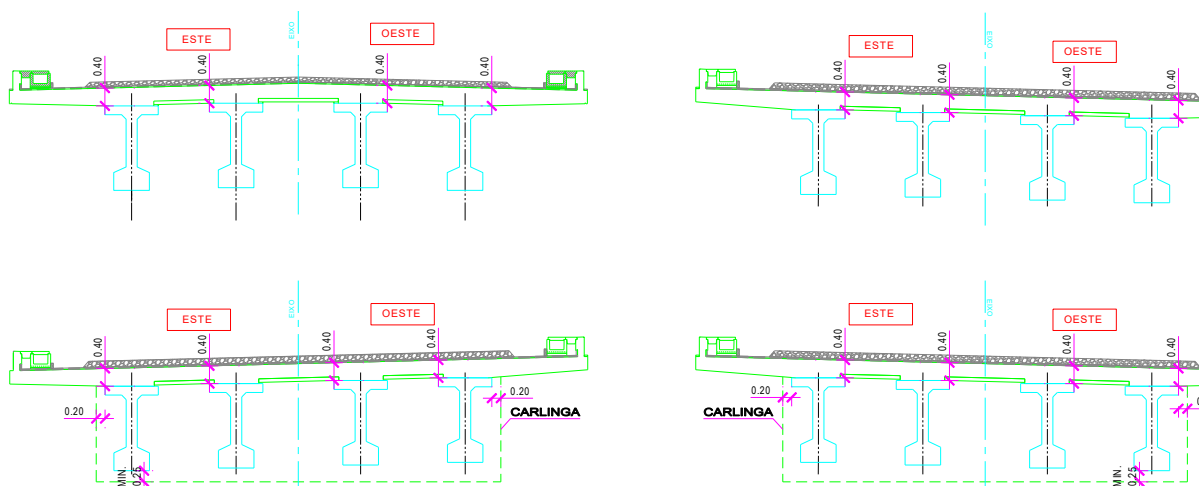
Pontos de controlo das vigas em função da inclinação da secção
